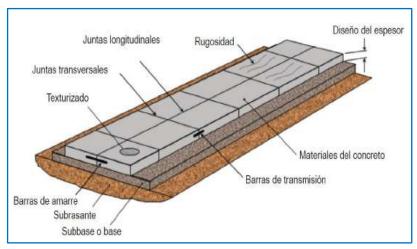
Componente estructural del pavimento rígido Fuente: Calo, 2010
